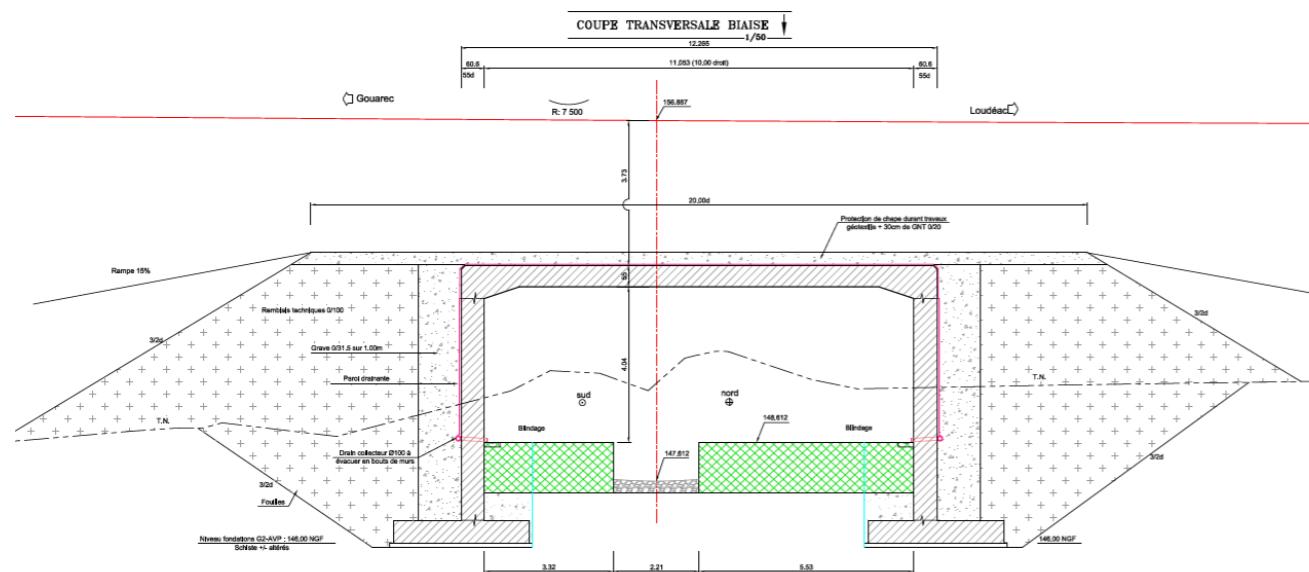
Coupe transversale de l'ouvrage OH12 (source : SEGIC)
